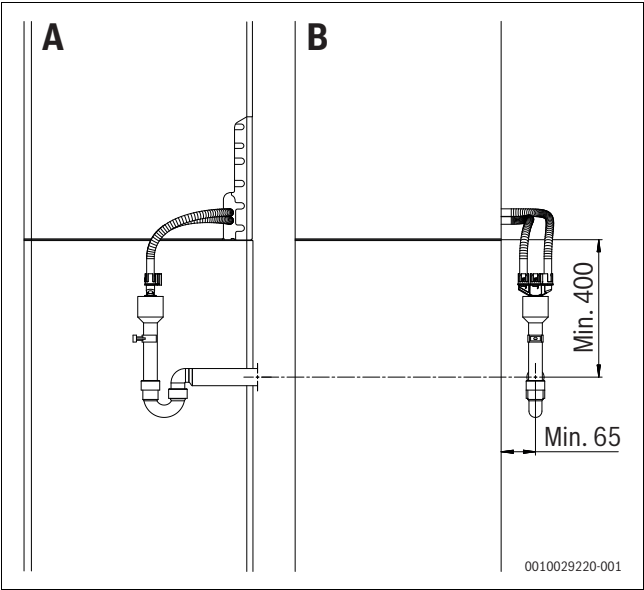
Aanzicht van de achterzijde (afmetingen in mm)
